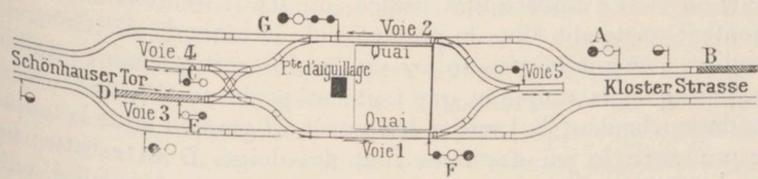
Plan du chantier de raccordement, établi au milieu de la Sprée.
